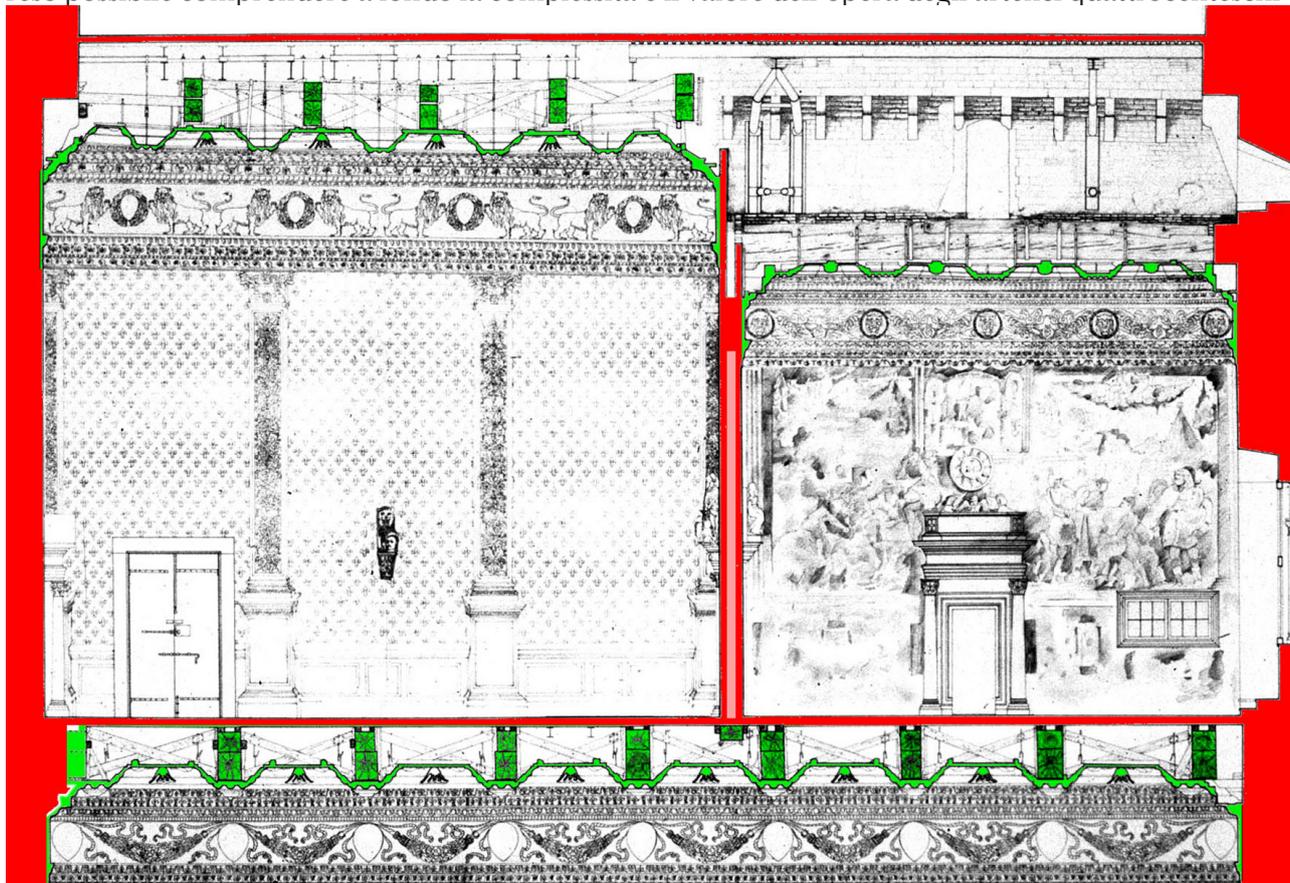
Sezione longitudinale parziale del palazzo con a sinistra la Sala dei Gigli e il soprastante soffitto, a destra la Sala dell'Udienza divisa dalla precedente da un muro in falso, sotto di esse la sezione del solaio e del soffitto cassettonato della Sala del Consiglio con il grande fregio ligneo (elaborazione da BIFFINO, BURRESI 1997).
